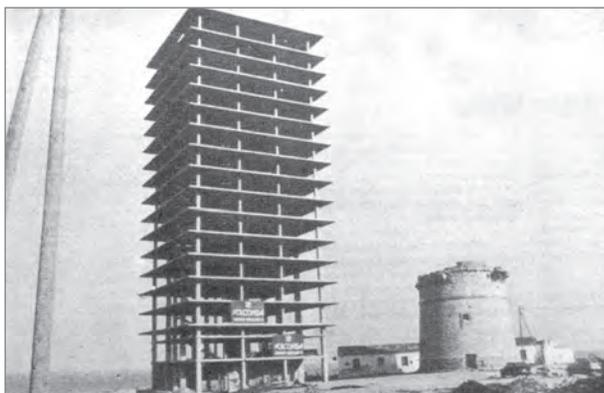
Fotografía de la torre de vigilancia y la estructura del edificio en construcción.
